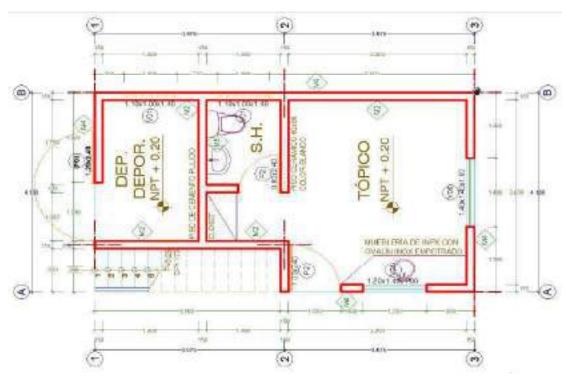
Distribución arquitectónica típica primera planta en tópico y guardianía -bloque 05
